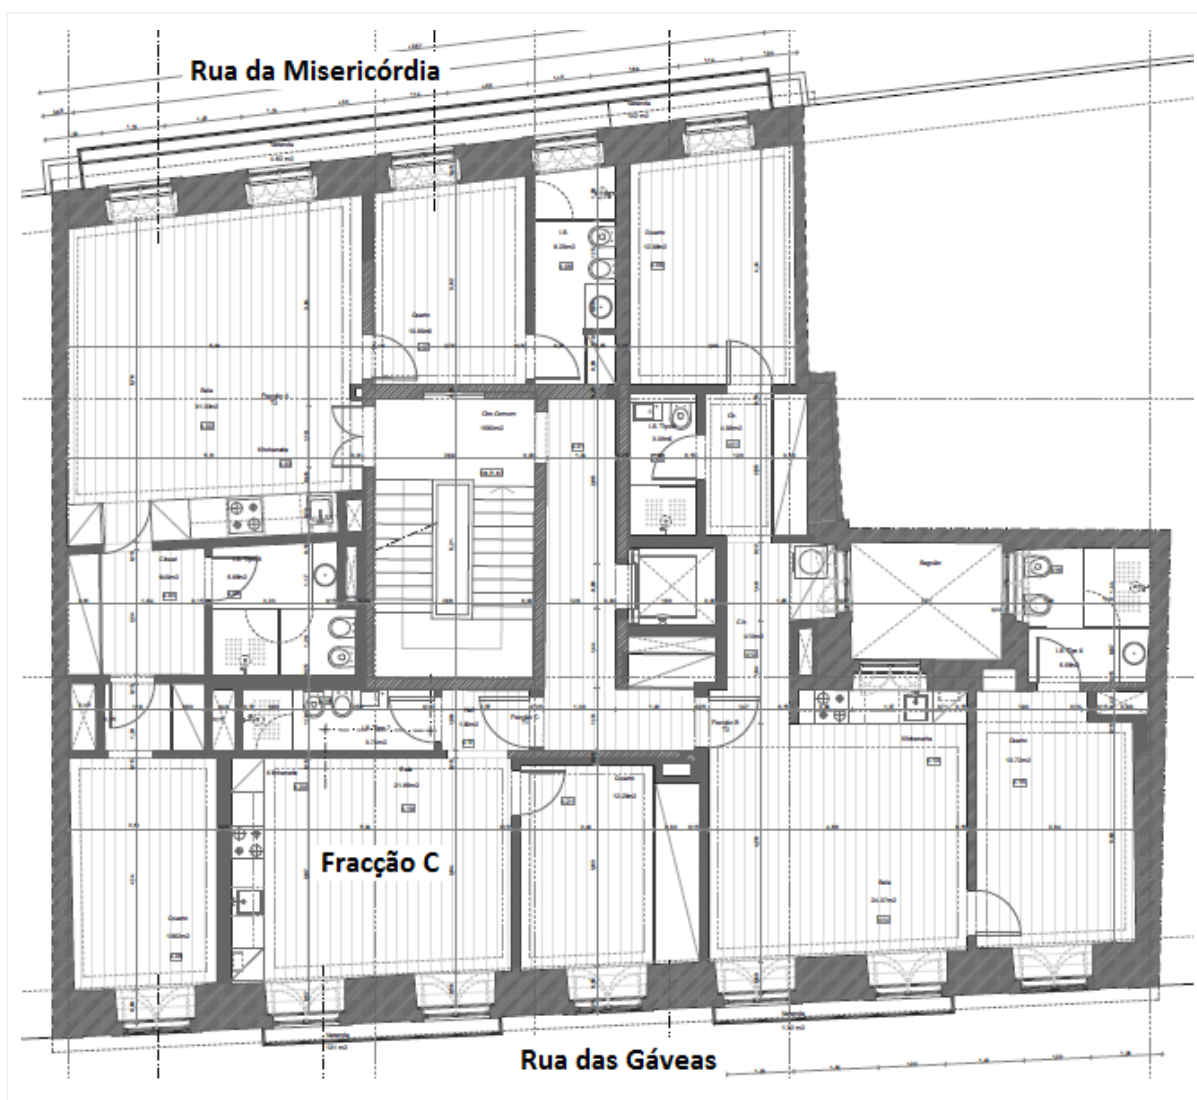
Planta Piso 4 – Fracção C local de ensaio E4
